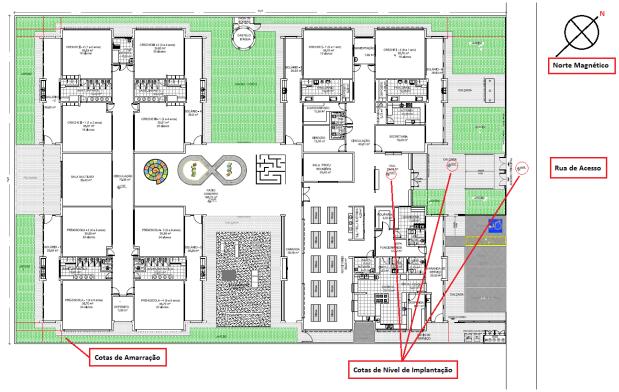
Exemplo de "Planta de Locação" da obra da Creche Tipo 1.
